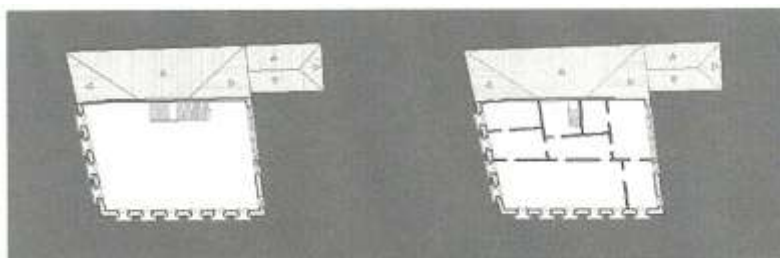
Plantas de reconstrução 3º pavimento: antes e depois da intervenção (1946-1952)
